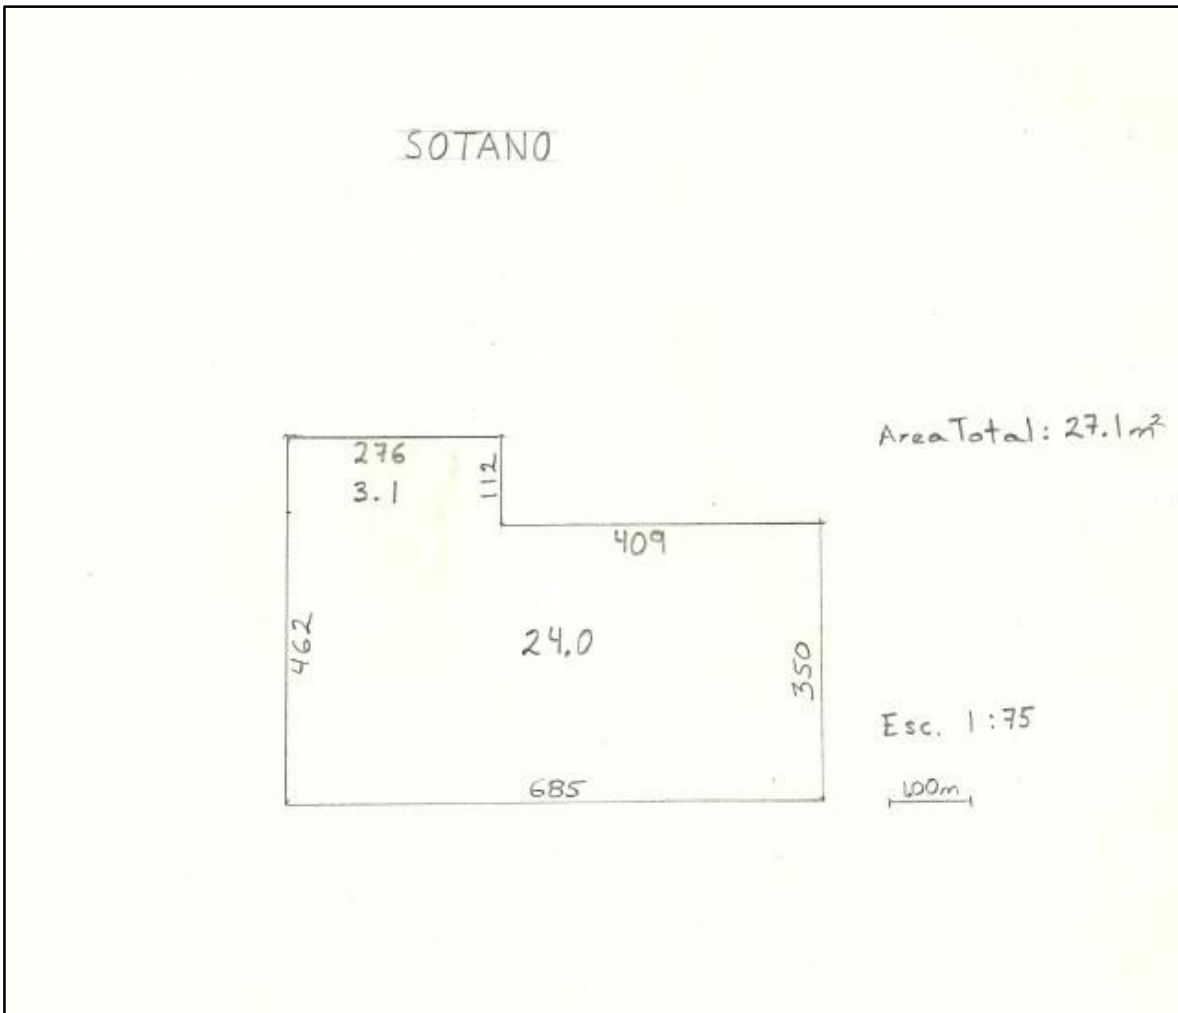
Plano edificio Santa Isabel sótano. Fuente
